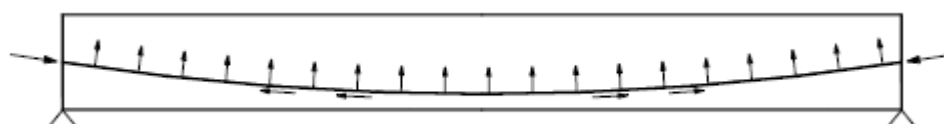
Ações exercidas pelas armaduras de pré-esforço sobre o betão (retirado de Appleton *et al*, 2014b)
